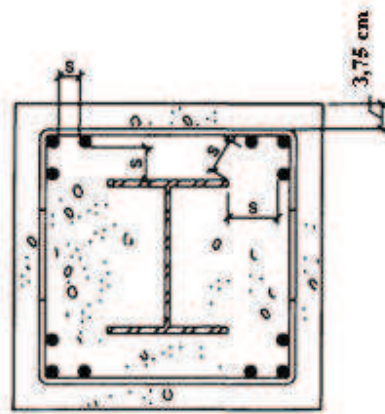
Distribución de refuerzo longitudinal en las columnas compuestas [3]
